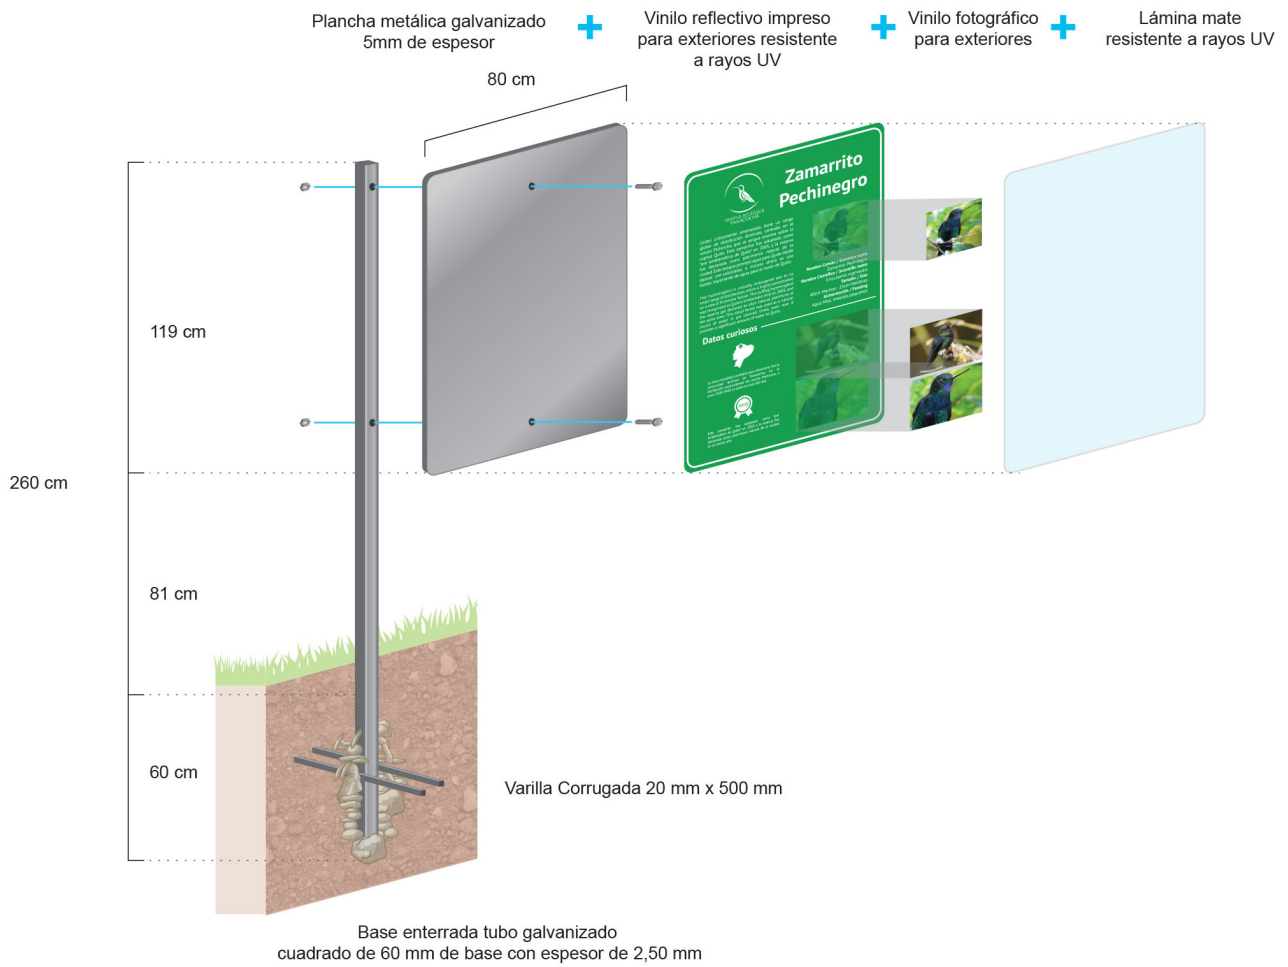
Detalle constructivo para elementos señaléticos interpretativos.
